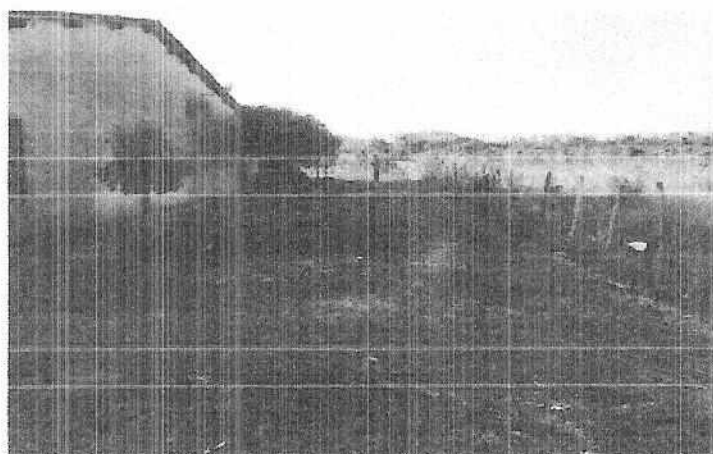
Local de implantação da pavimentação(TRAVESSA SDO, DISTRITO DE CAMPANÁRIO)
